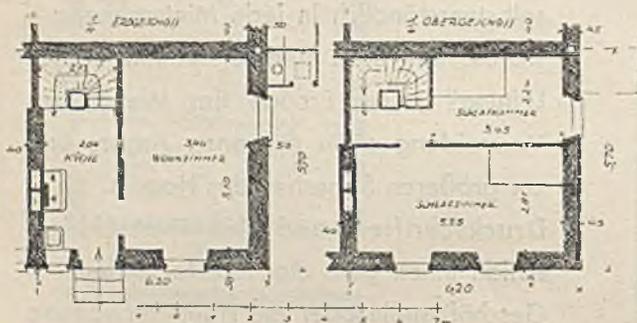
Kreuz-Grundriß, zweigeschossig, 4 Wohnungen.
